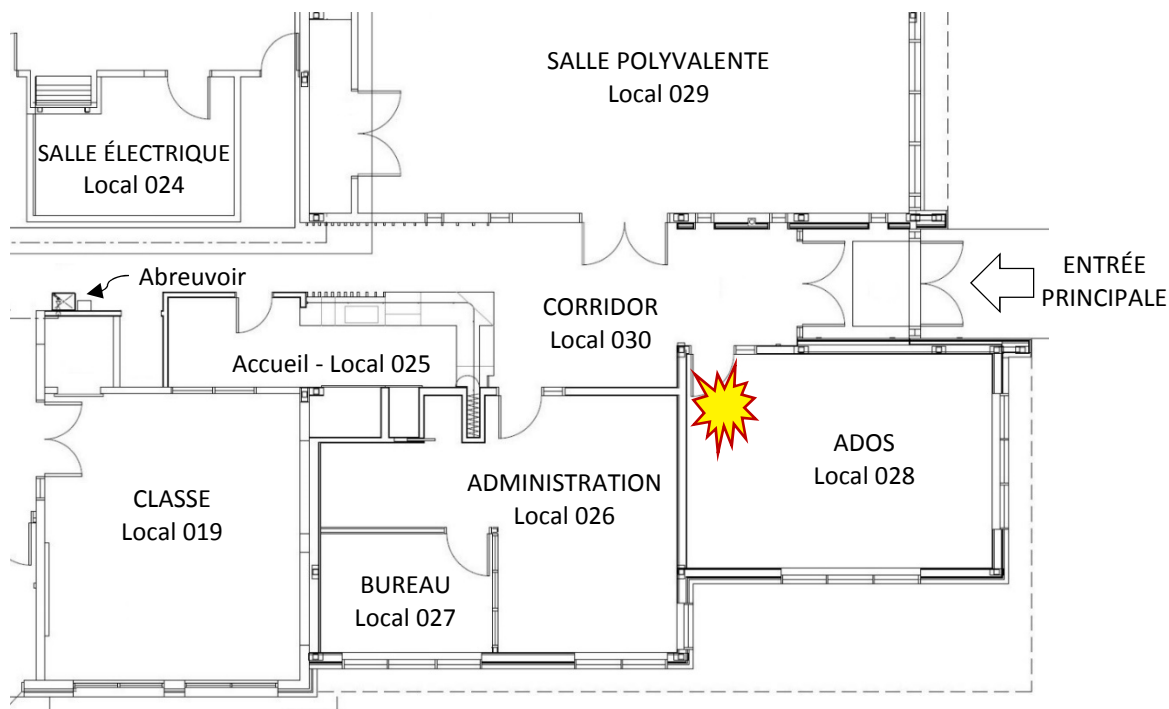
Lieu de l'accident sur un extrait du plan du Pavillon de la Savane
